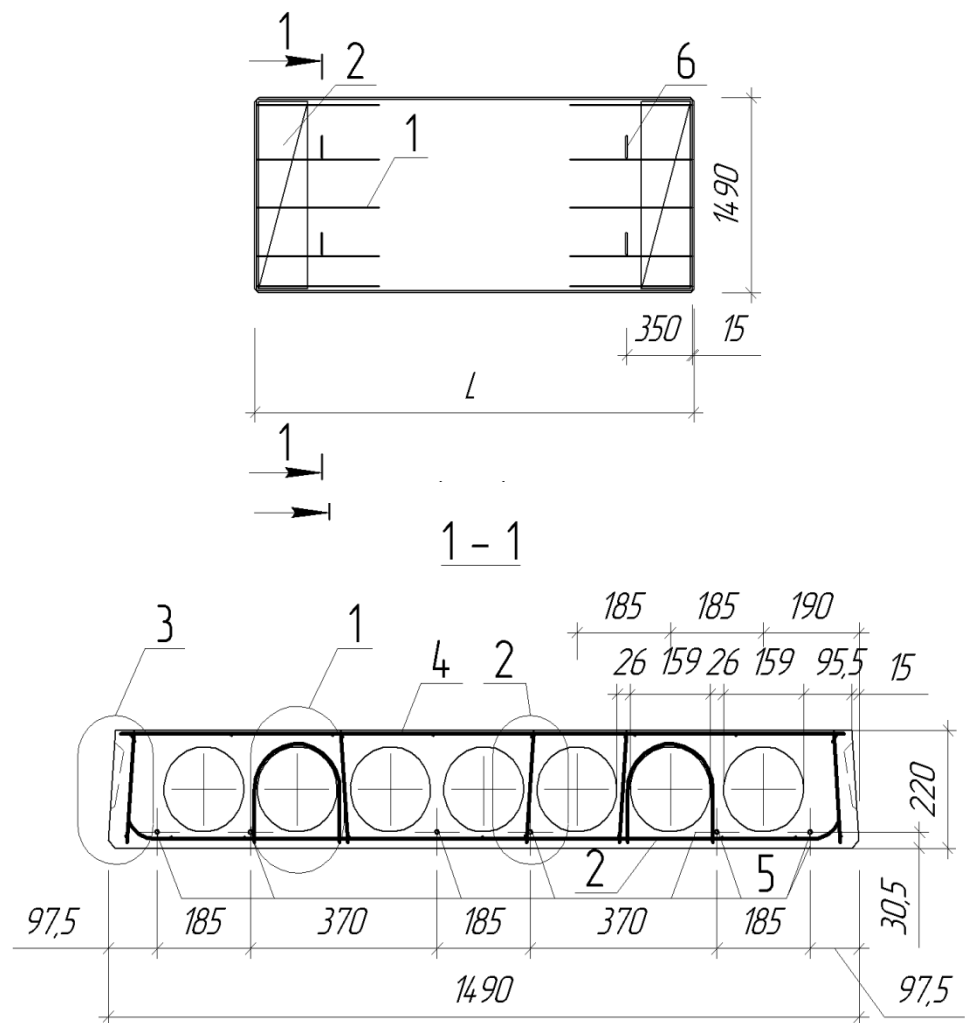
Конструкция пустотной панели: 1- каркасы с поперечной арматурой в ребрах панели; 2 – сетки косвенного армирования, усиления зон передачи усилия предварительно напряженного; 4 – конструктивная сетка армирования верхней полки; 5 – продольная предварительно напряженная рабочая арматура; 6 – строповочная петля
